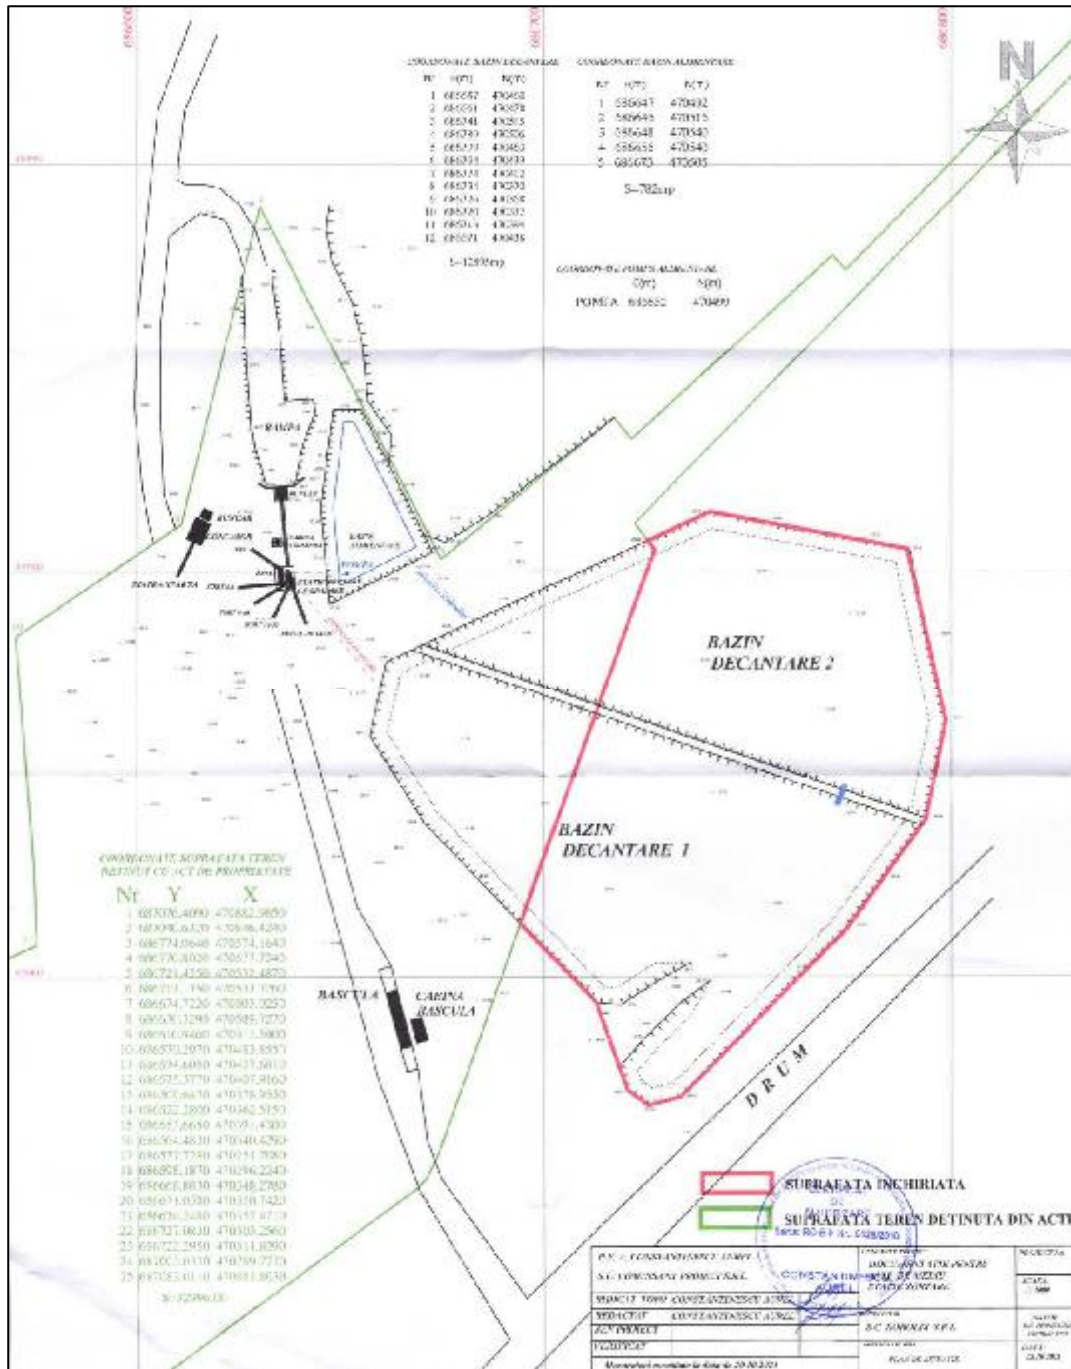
Plan de situație – Perimetrul Umbrărești T24
